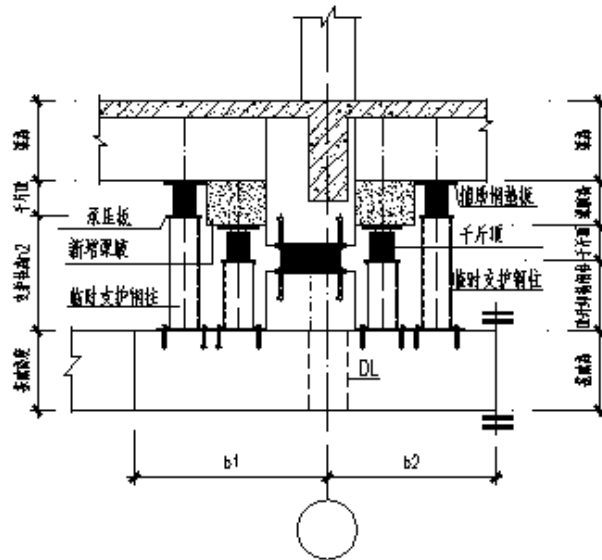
柱节点顶升荷载、支护钢柱安装平面图1
